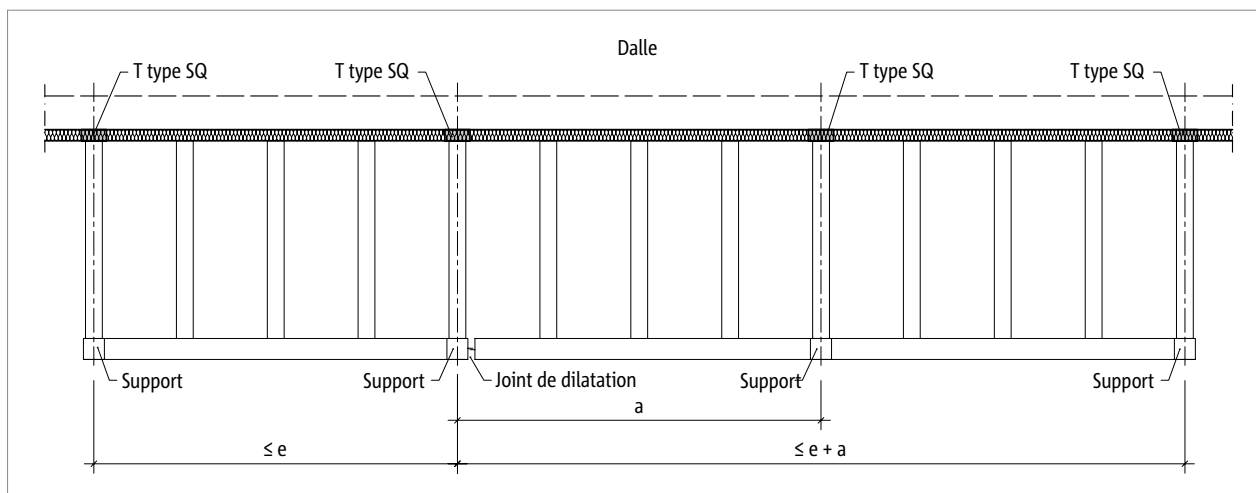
Schöck Isokorb® T type SQ : Distance maximale du joint de dilatation e et porte-à-faux latéral a
